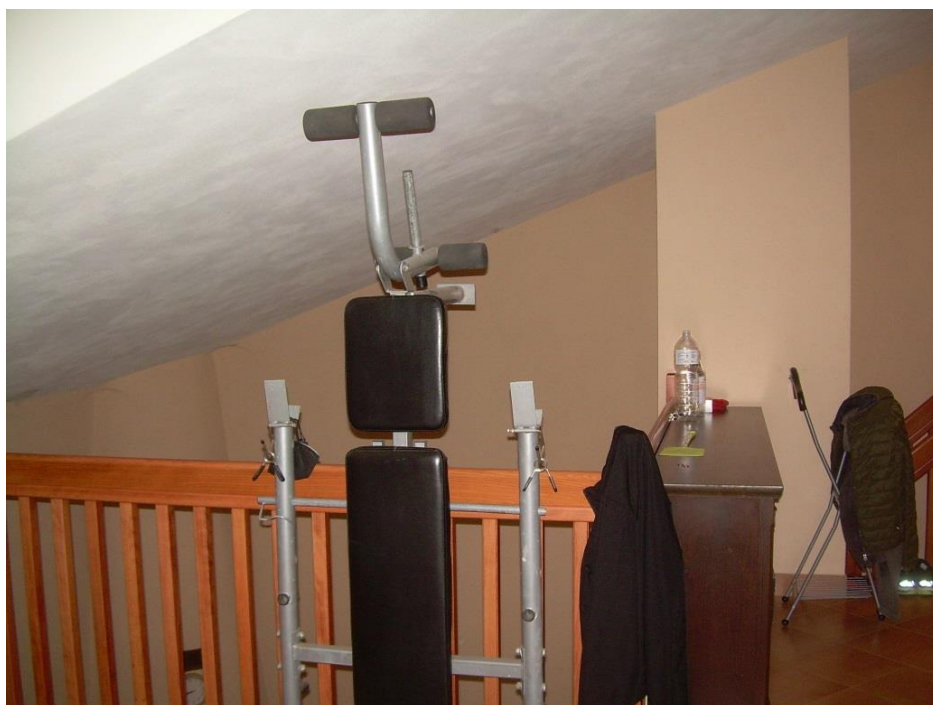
area del vano pluriuso e lucernaio sottofalda del tetto.
